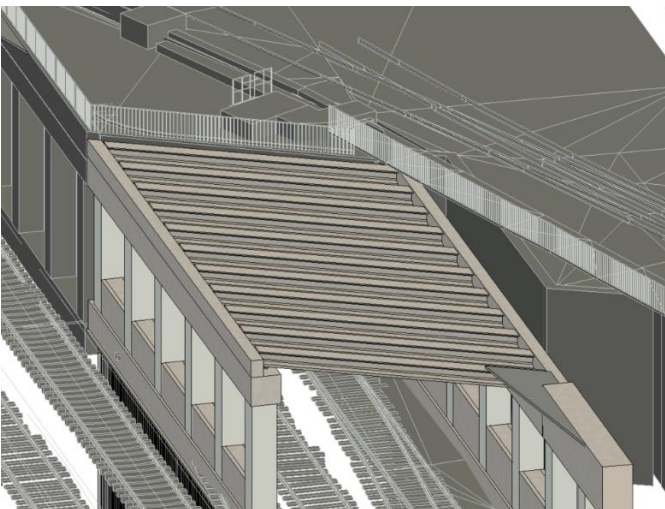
Vista 3D del modelado de la pérgola 1, se ha ocultado el tablero para mostrar las vigas prefabricadas
